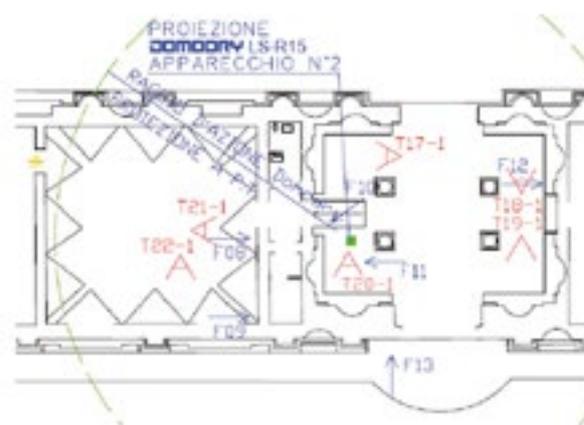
Palazzo Te, Mantova - Schema planimetrico con ubicazione prove (termografie IR e foto del degrado superficiale) e foto installazione apparecchi Domodry®.
